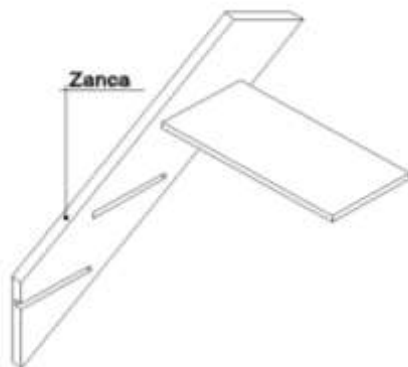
Detalle constructivo – Anclaje de peldaños a zanca de grada
